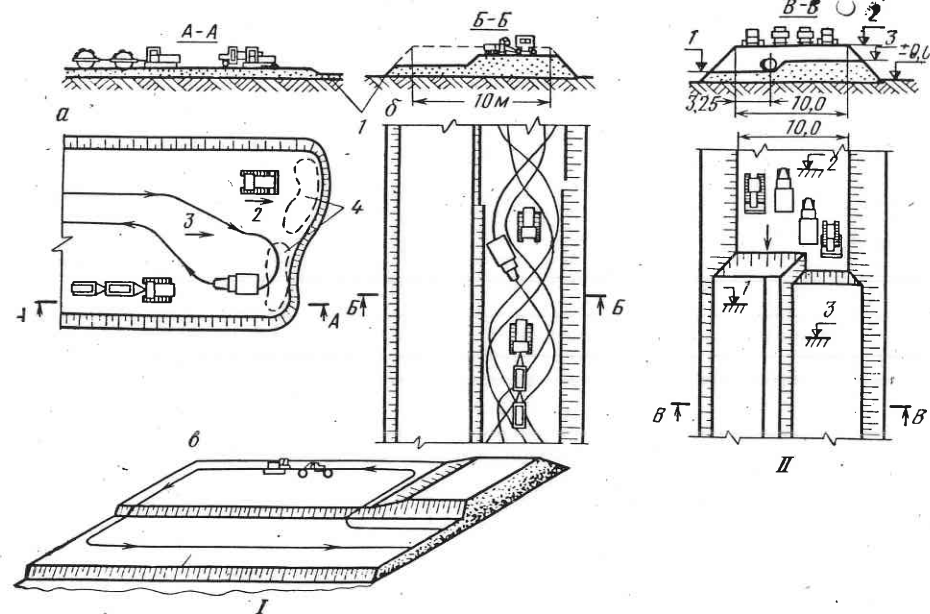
Схема выполнения земляных работ на насыпи:
